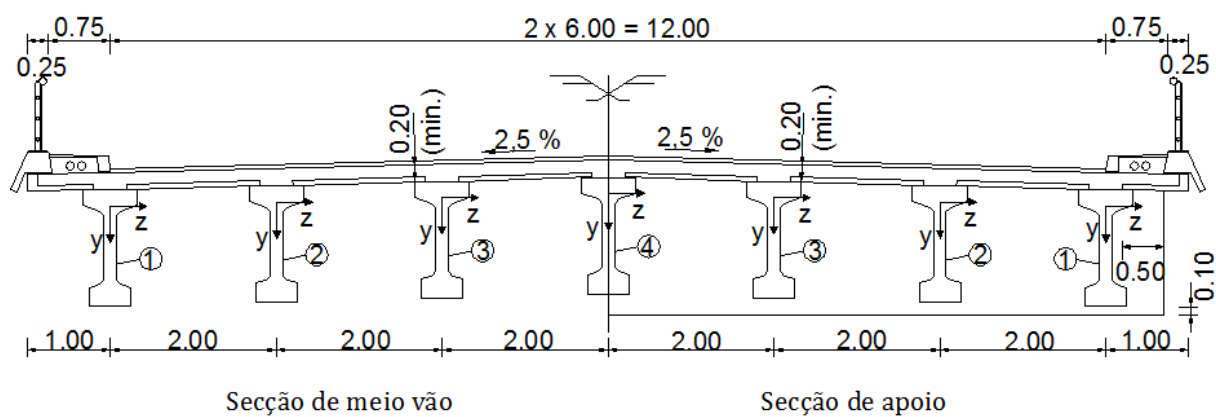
Secção transversal do tabuleiro do caso de estudo 4.
